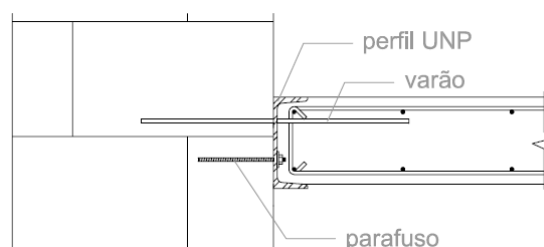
Apoio da laje de betão através de perfil U.
